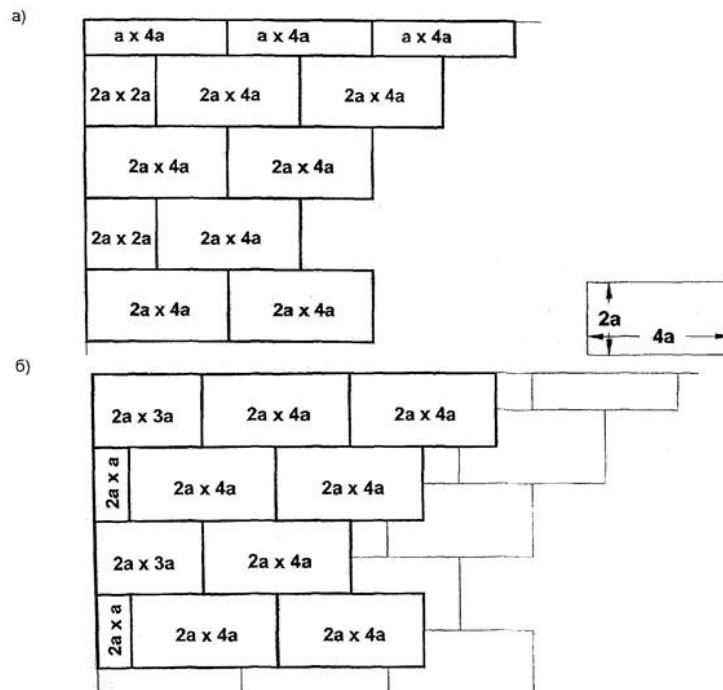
Розкладка теплоізоляційних плит нижнього (а) і верхнього (б) рядів
